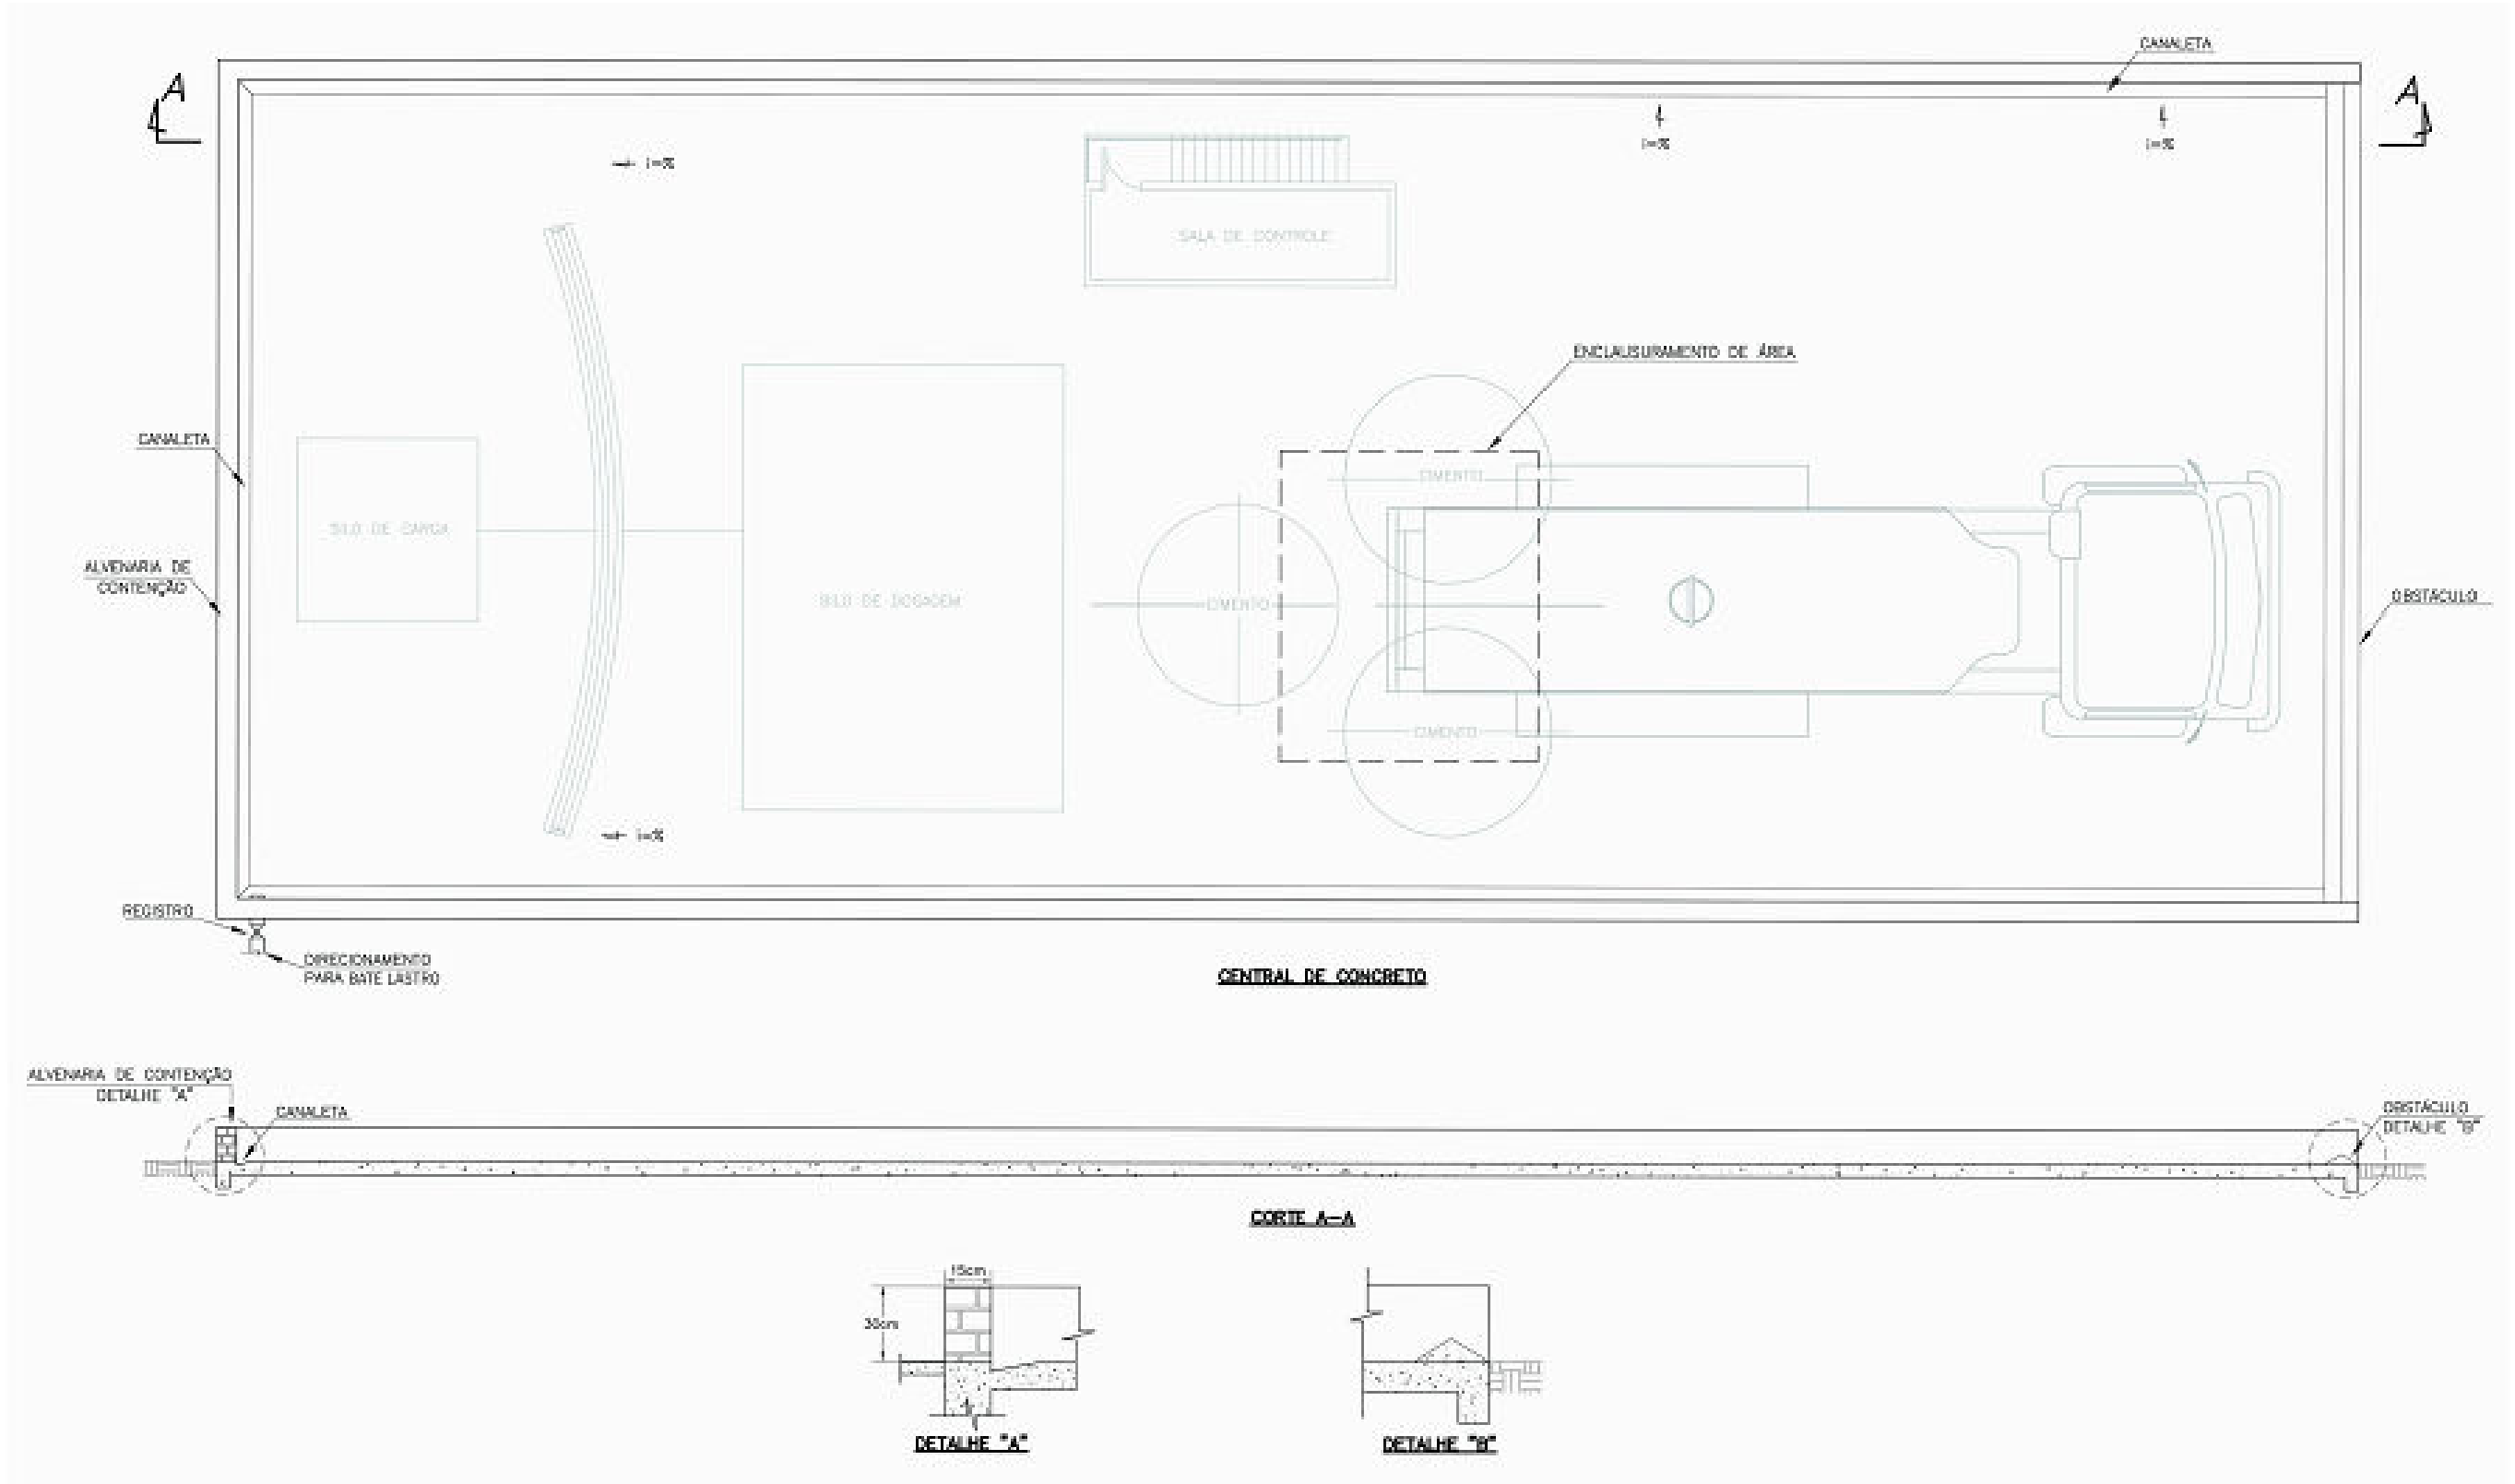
Instalação temporária da Central de Concreto
